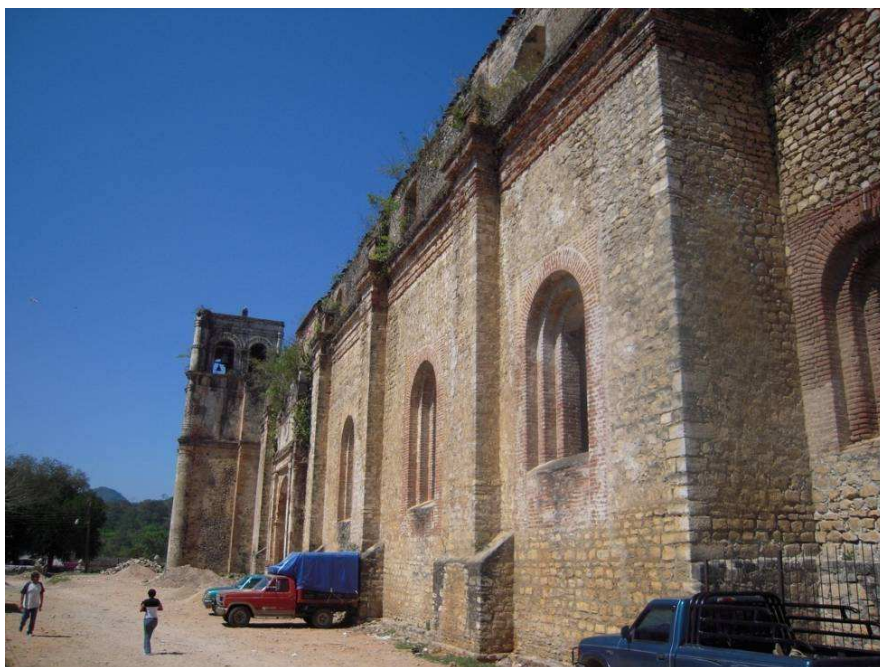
Vista lateral del muro sureste del templo y al fondo vista del lado de la Torre (fotografía de la autora).
